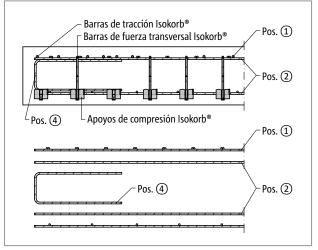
Schöck Isokorb® T tipo K-M1 hasta M11: Armadura in situ del lado del balcón en la sección A-A; pos.4 = refuerzo constructivo en el borde libre perpendicular al Schöck Isokorb®
